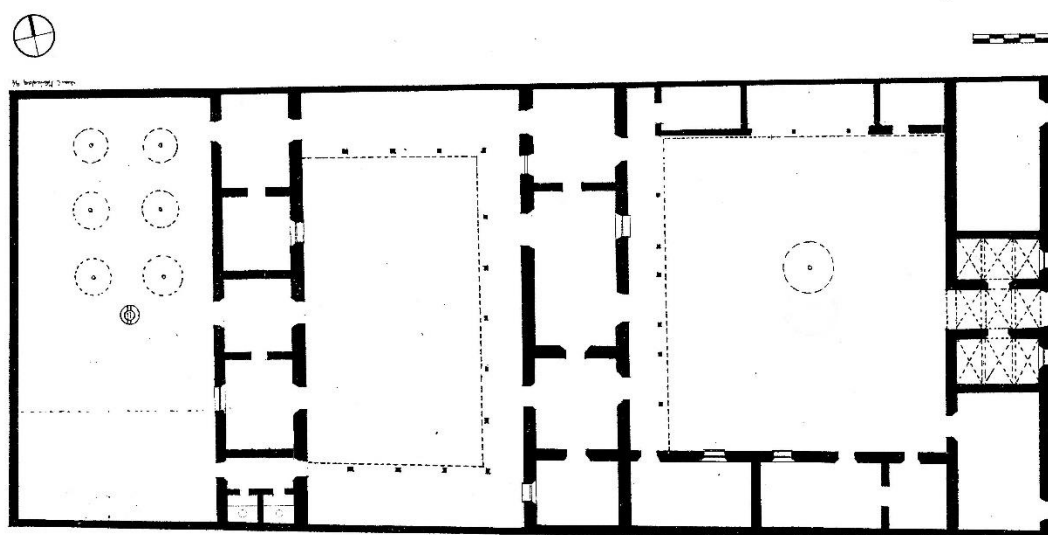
Planta de la Casa en 1838. Elaboración propia
